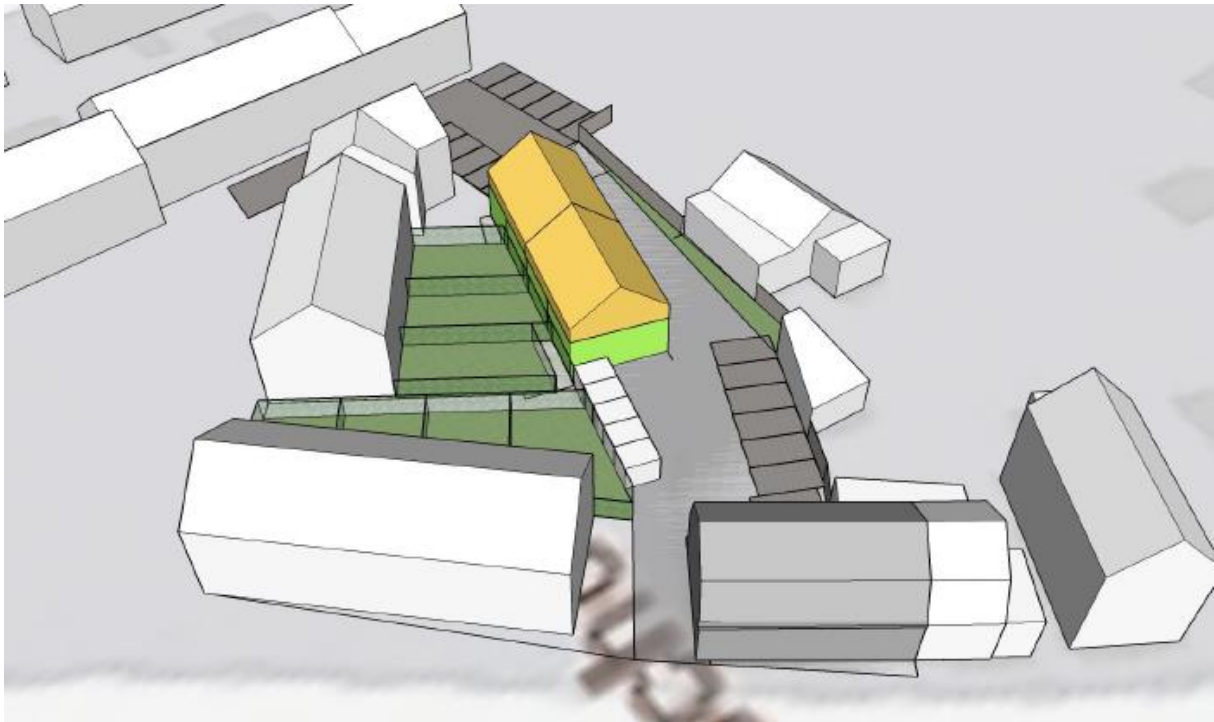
Zicht op plangebied vanaf de Grootschoterweg uit noordelijke richting, met rechts de woonbebouwing en links de voormalige bedrijfsbebouwing
